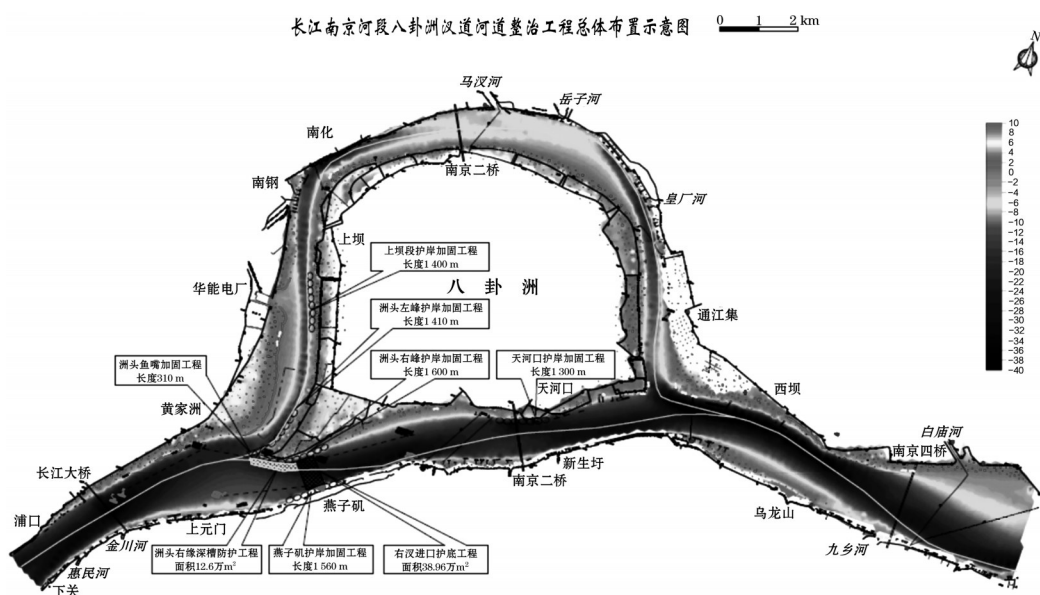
长江南京河段八卦洲汊道河道整治工程施工平面布置
